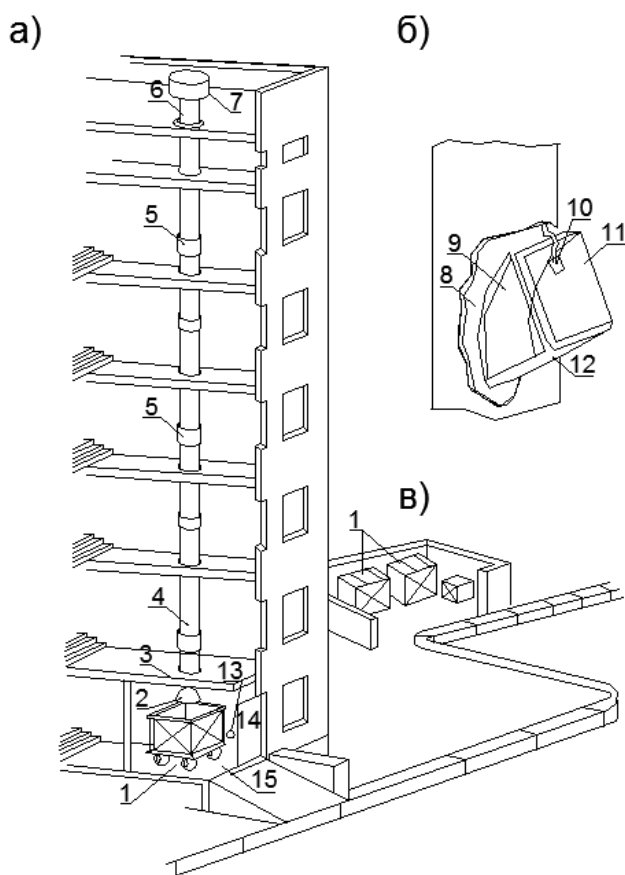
Система мусороудаления: а - мусоропровод; б - загрузочный клапан; в - площадка для контейнеров: 1 - контейнер; 2 - шиберное устройство; 3 - нижняя часть ствола; 4 - вертикальный ствол; 5 - загрузочный клапан; 6 - вентиляционная труба; 7 - дефлектор; 8,9 - козырек; 10 - ручка; 11 - подвижная коробка; 12 - горизонтальная ось; 13 - поливочный кран; 14 - мусоросборная камера; 15 - трап.
